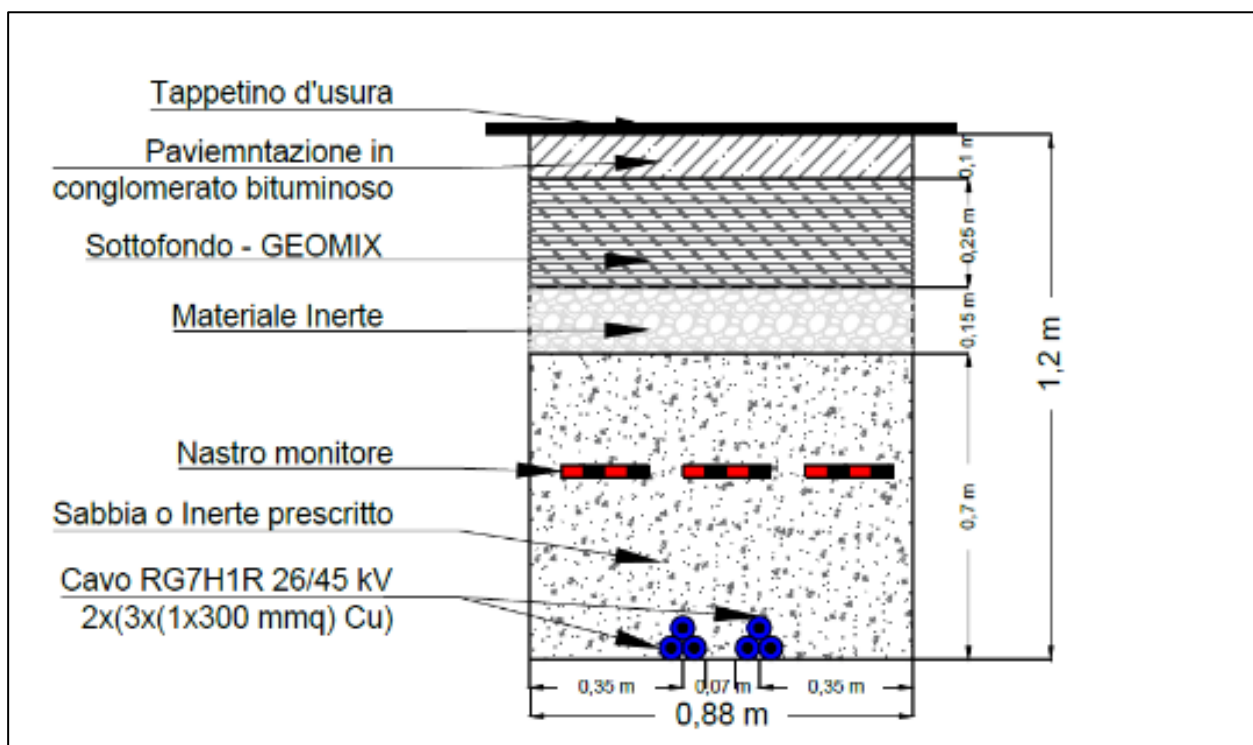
Tipico della sezione di scavo del cavidotto di connessione a 36 kV su strada asfaltata
